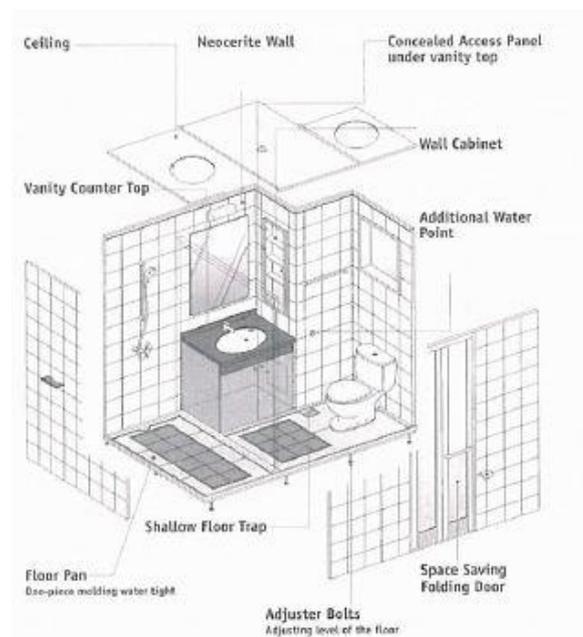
2D Las paredes, el techo y el suelo llegan prefabricados a la obra y se ensamblan in situ. (fuente: Google imágenes)
